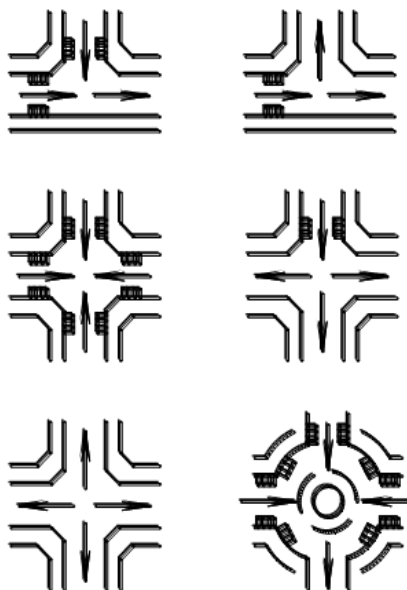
Схемы размещения дождеприемников у перекрестков
